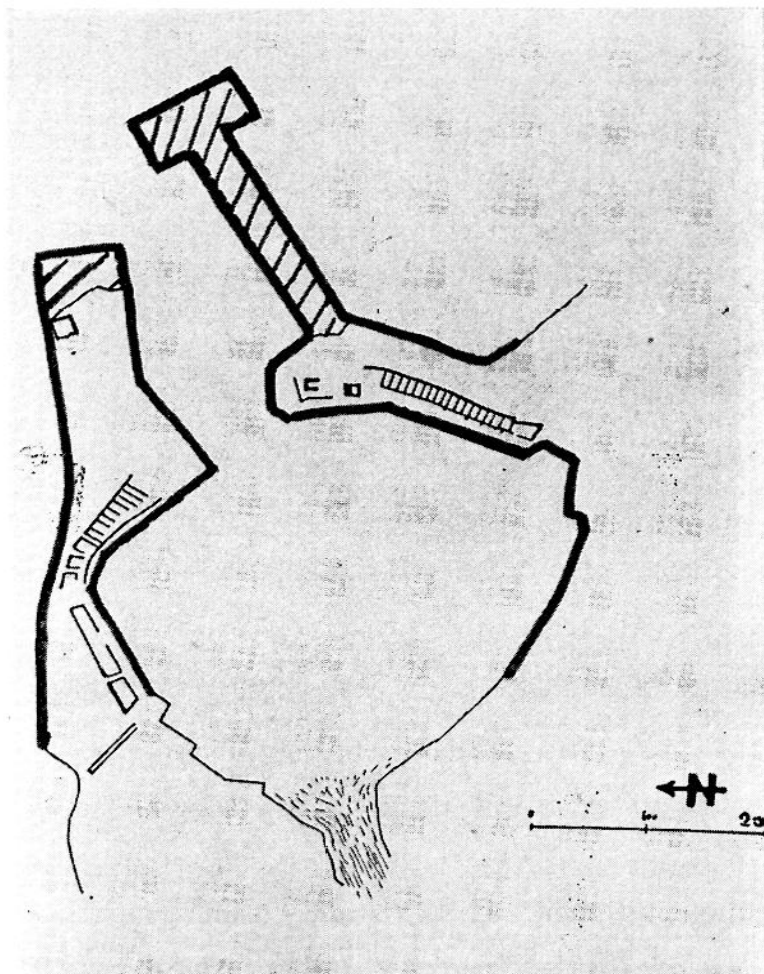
Plan du port avec, en hachures, les môles actuellement submergés (plan J. Pilon).
